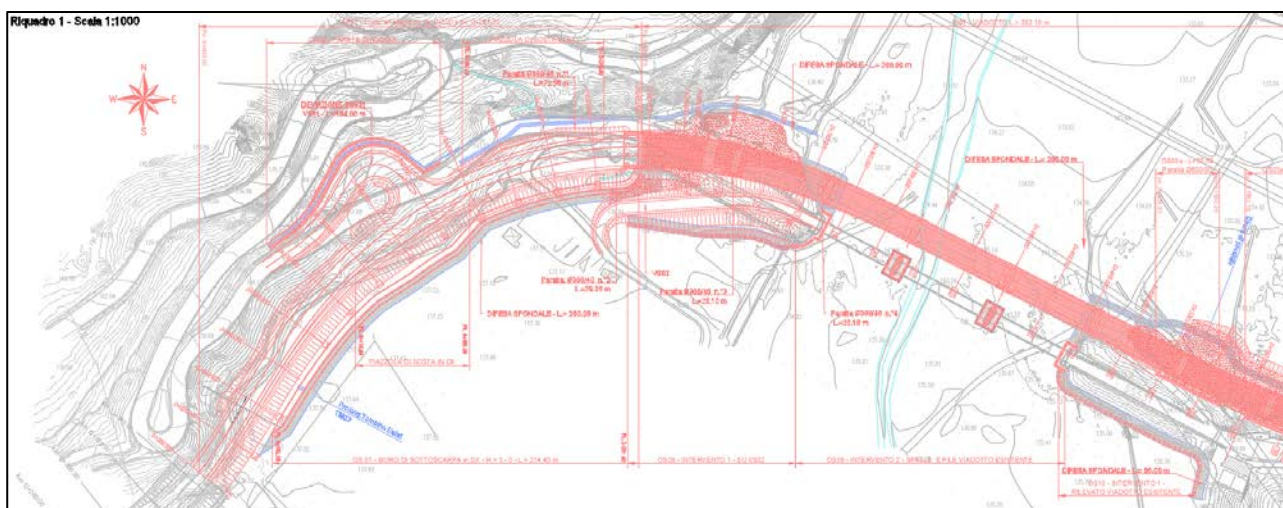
Planimetria di progetto da pk 0+000 a pk 0+400
